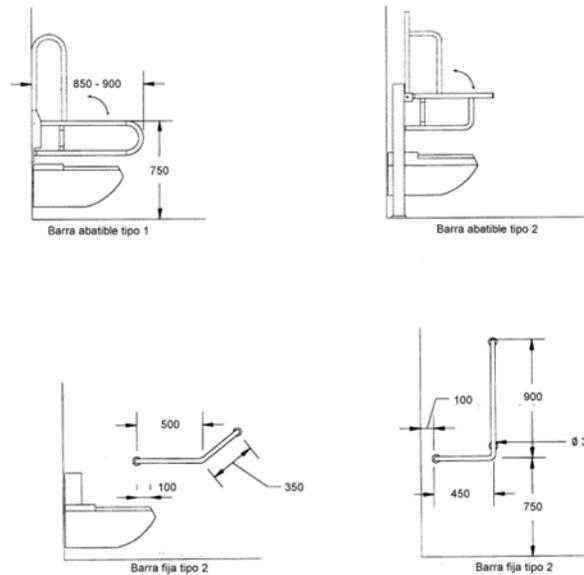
Forma y Disposición de la Barra de Apoyo en Alzado para Inodoro
